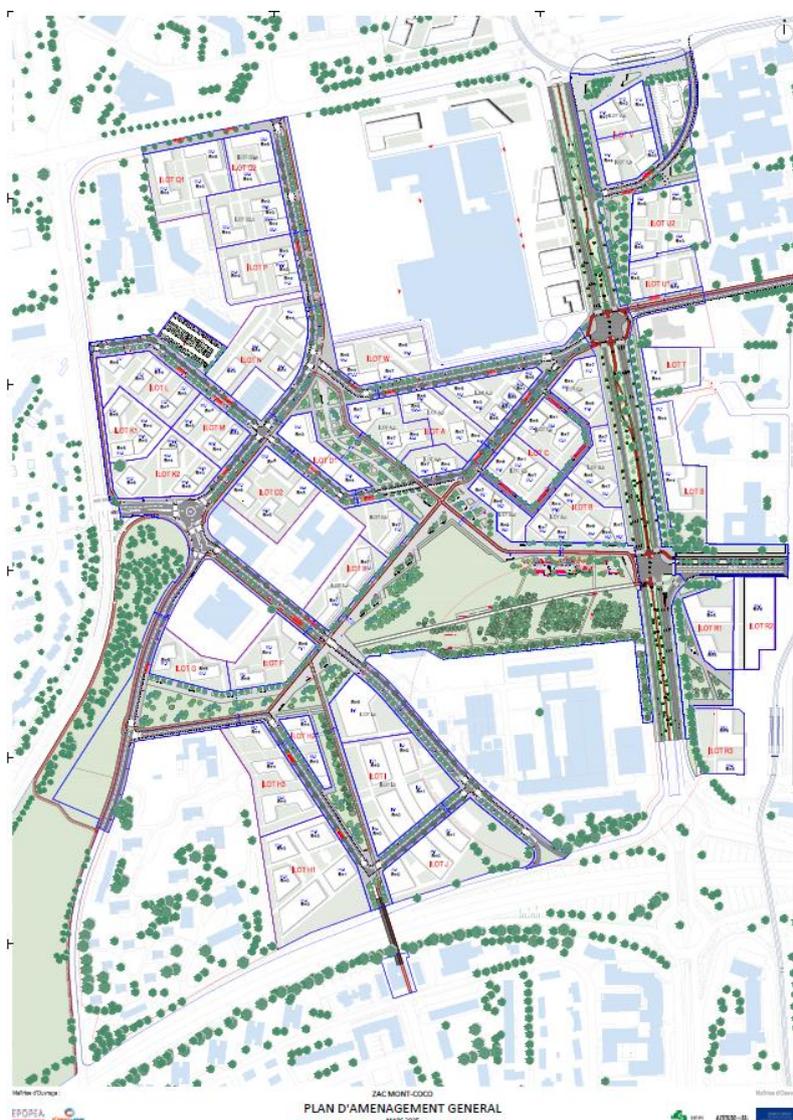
Plan d'aménagement général (source : Fernando Vega-Sanchez)
